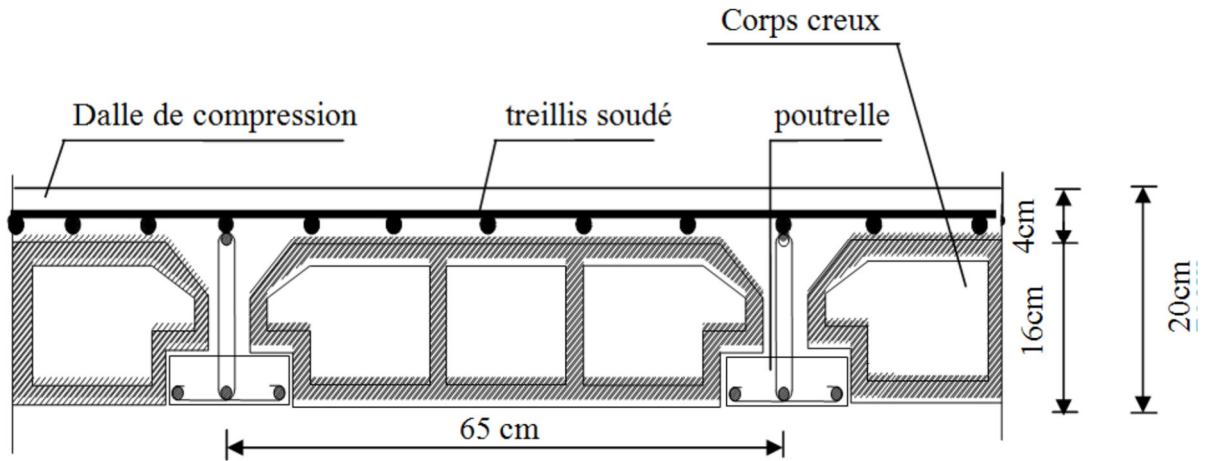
Coupe transversale d'un plancher à corps creux
